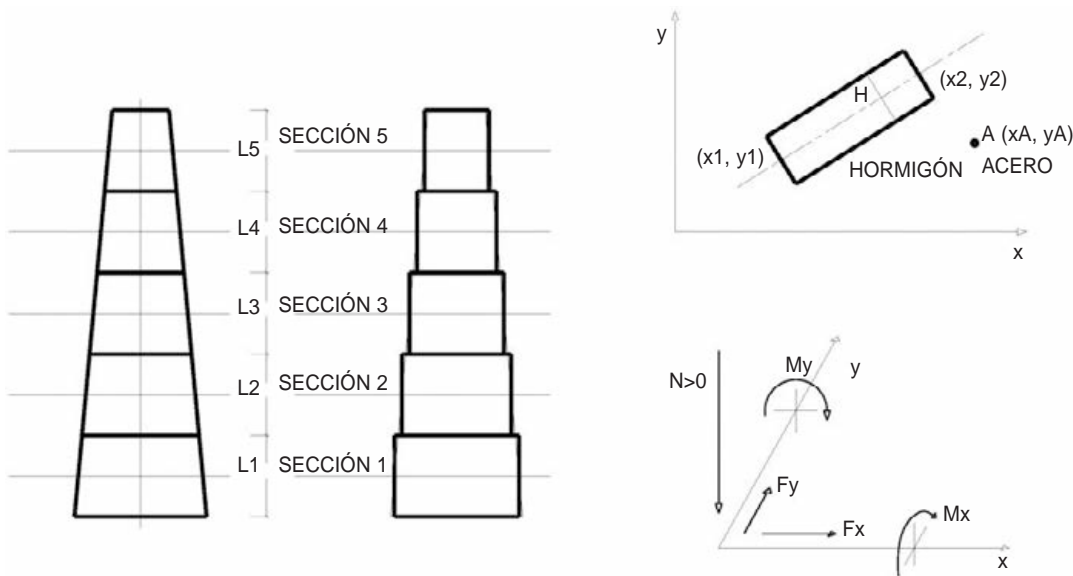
Modelización de la pila y de las secciones y de los materiales hormigón y acero en el sistema local de la sección.
